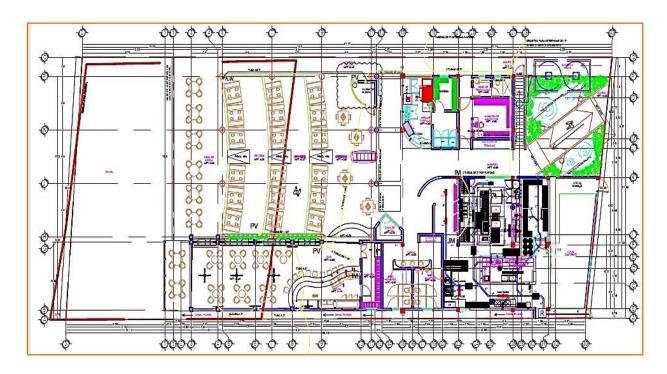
Plano arquitectónico de la Planta baja del proyecto.
